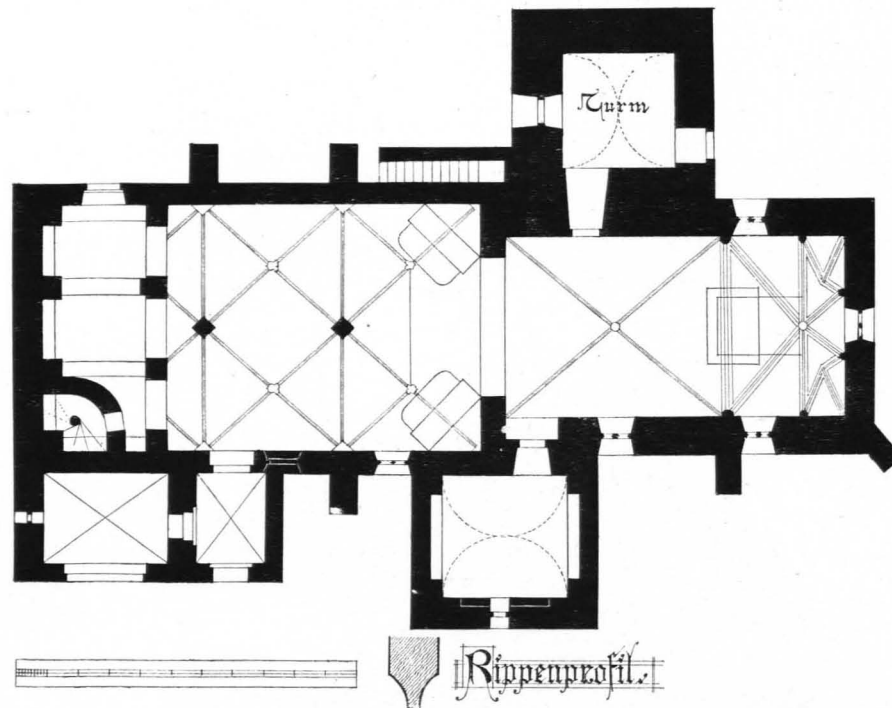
Neukirchen an der Wild, Pfarrkirche, Grundriß 1 : 250 (S. 437)
